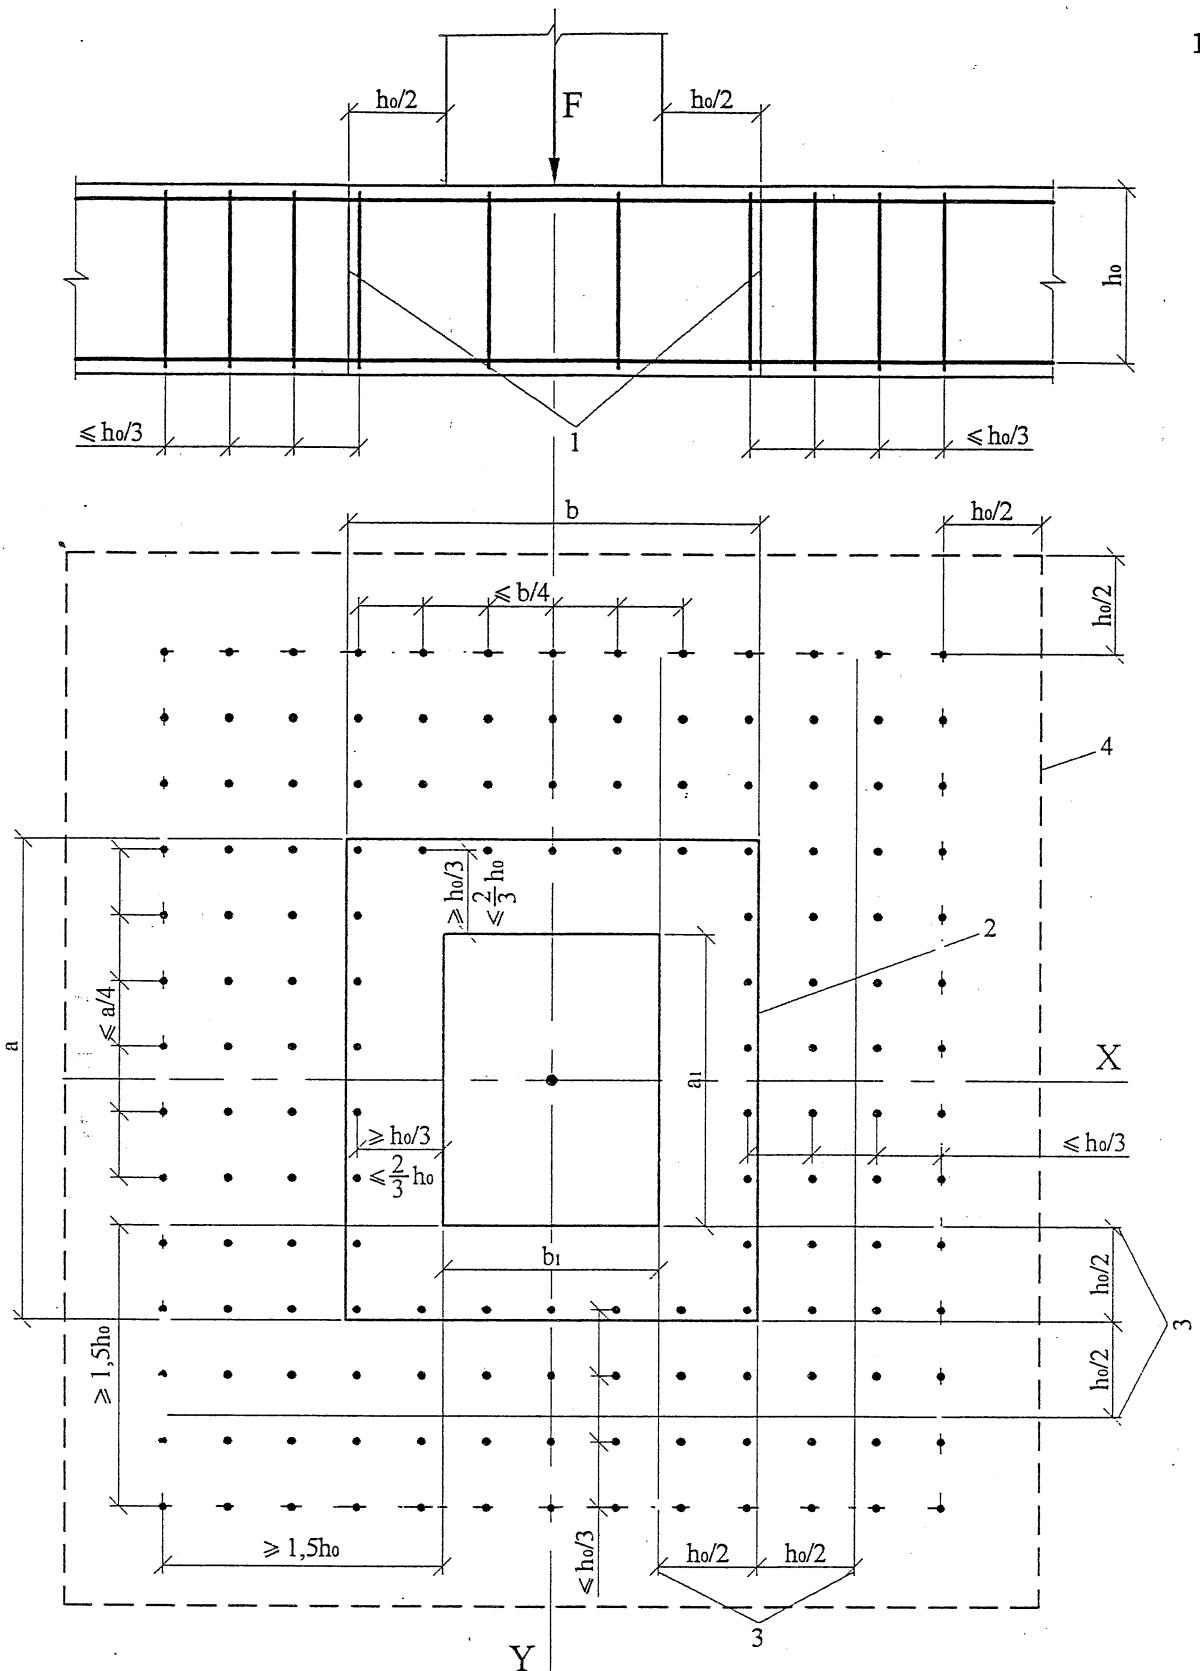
Схема для расчета железобетонных плит с вертикальной равномерно распределенной поперечной арматурой на продавливание
